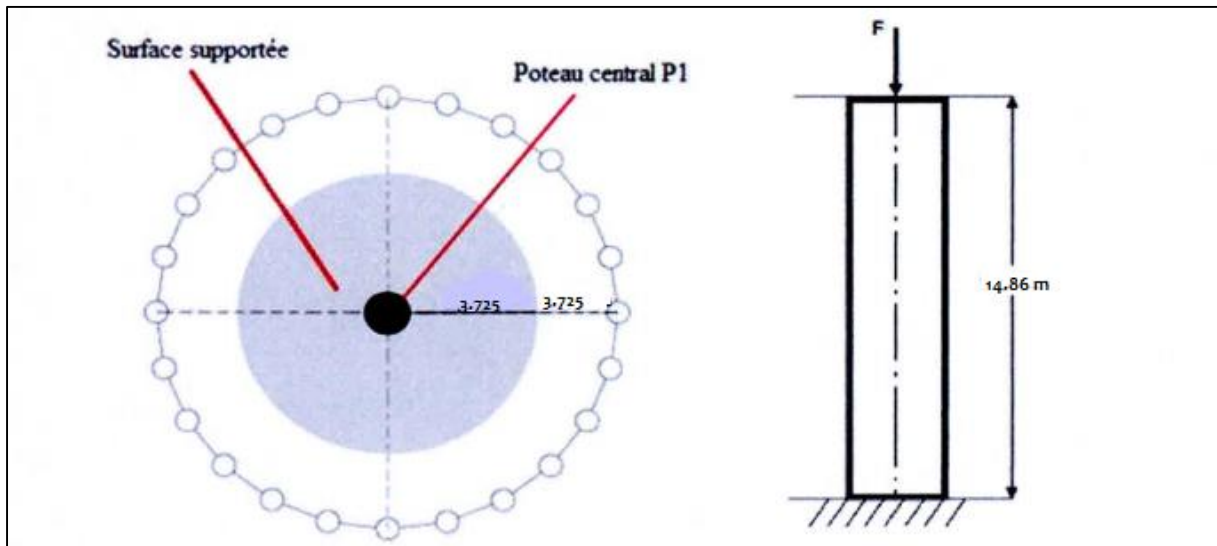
Surface supportée par le poteau central et modélisation du poteau central
